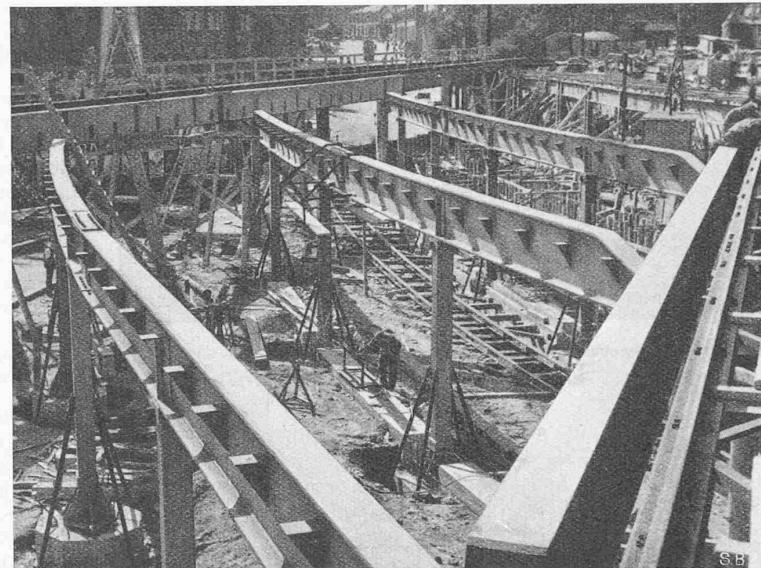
Montage des Stahlbaues von Los 5b (Neubrückstrassen-Unterführung)
